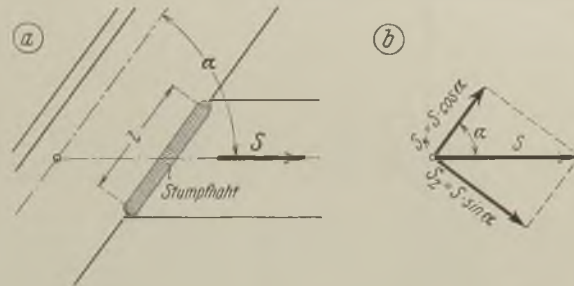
Stabanschluß mit schräger Stumpfnah
